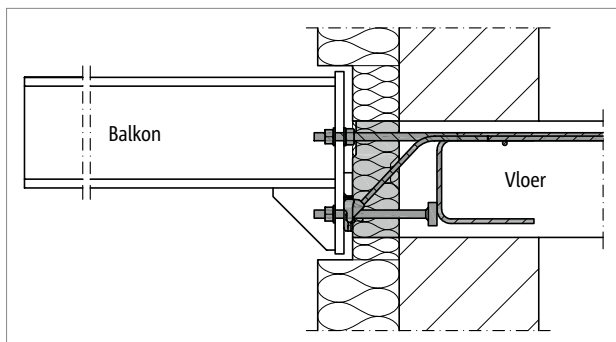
Schöck Isokorf® T type SK: vrij uitkragend balkon
